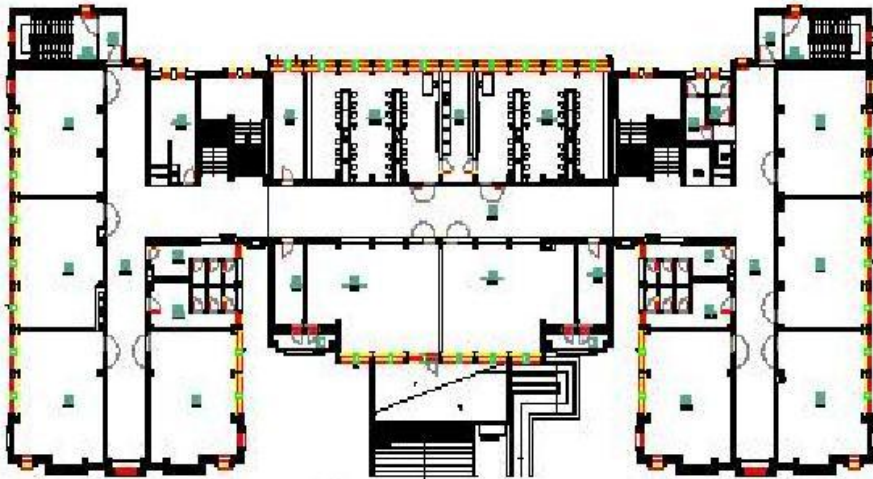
Alpaslan İ.Ö.O. zemin kat plan
